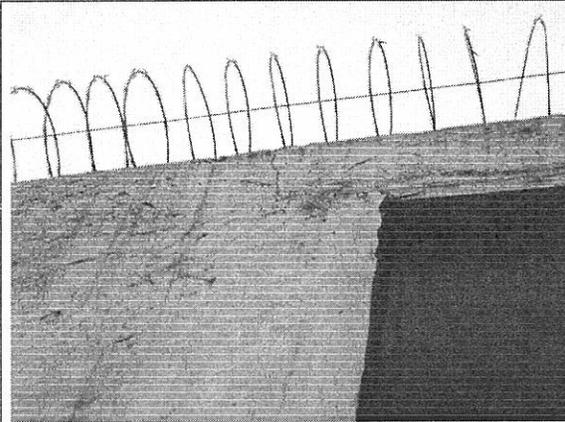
Fisuras en los sitios de apoyo del dintel.
